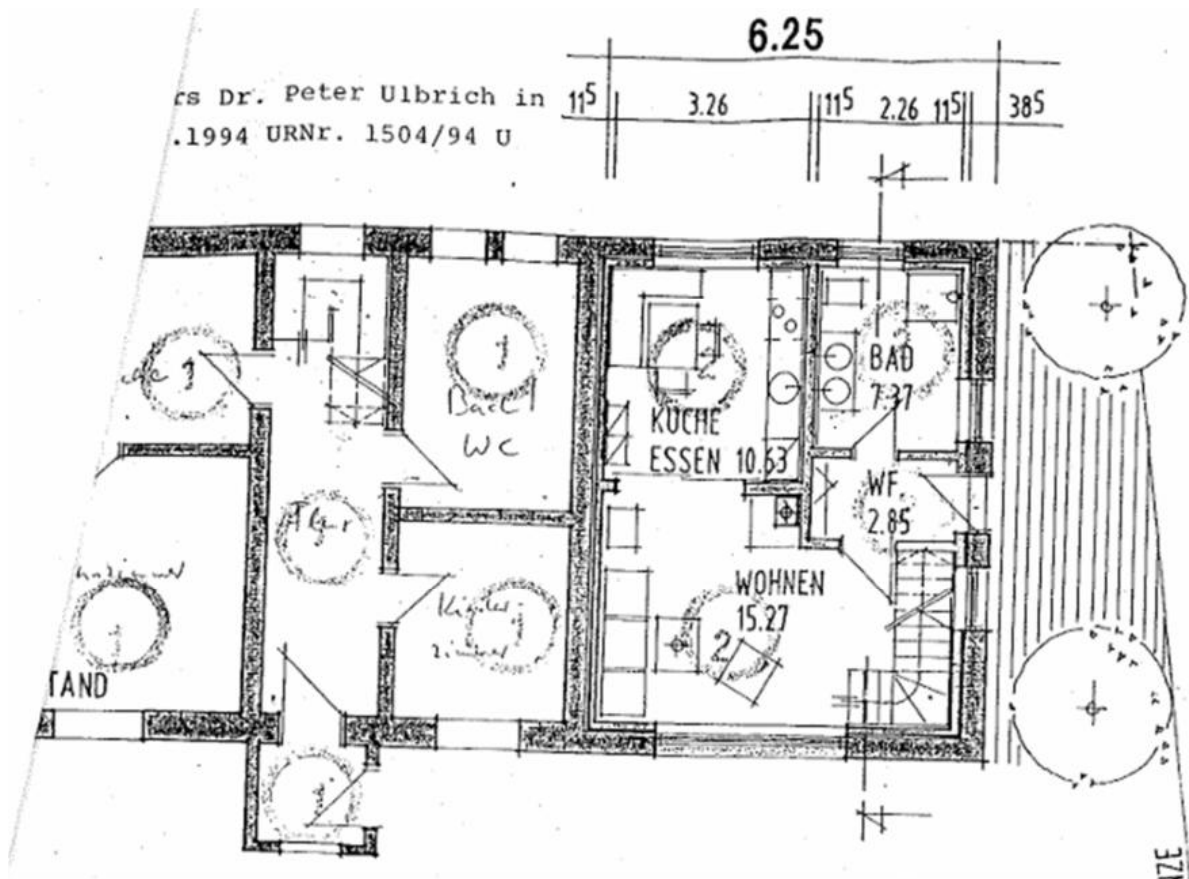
Grundriss Erdgeschoss (Auszug aus der Bewilligung 1994)
